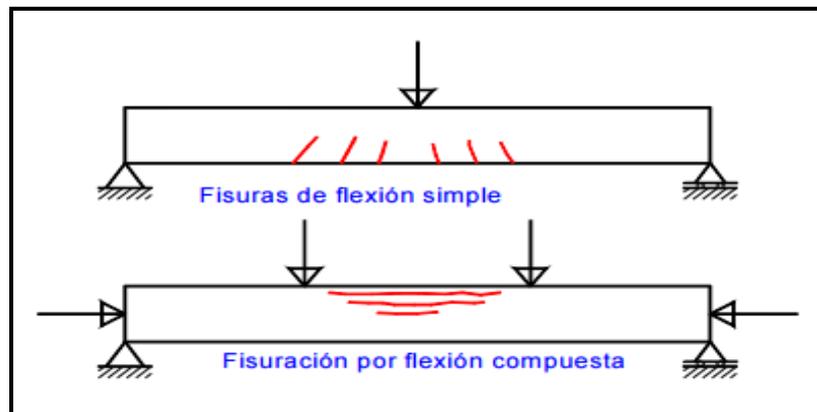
Fisuración por flexión de una viga.
